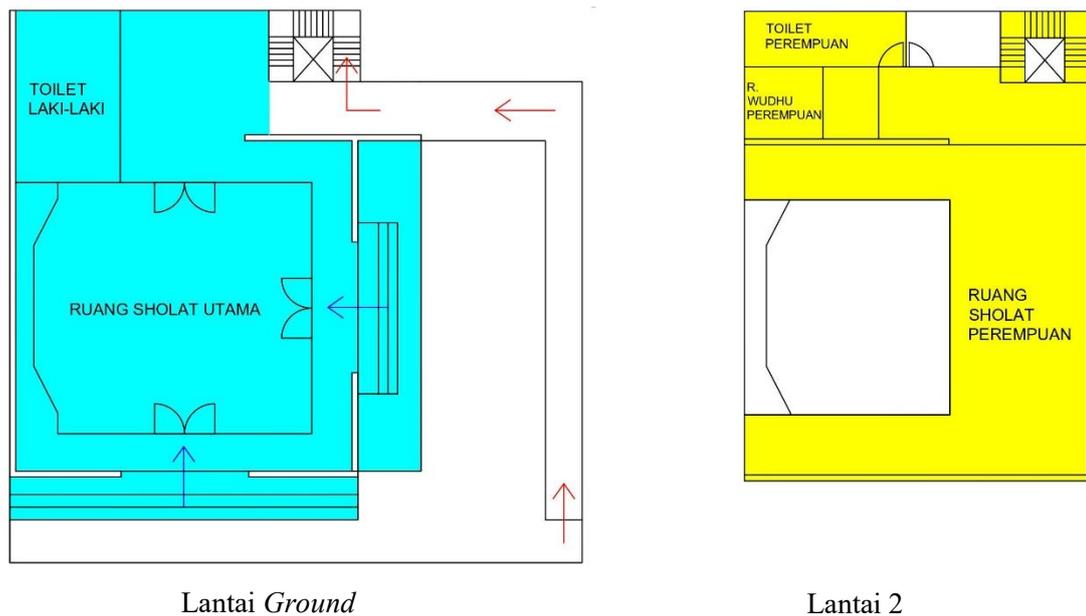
Site plan pada Masjid Siti Aisyah
